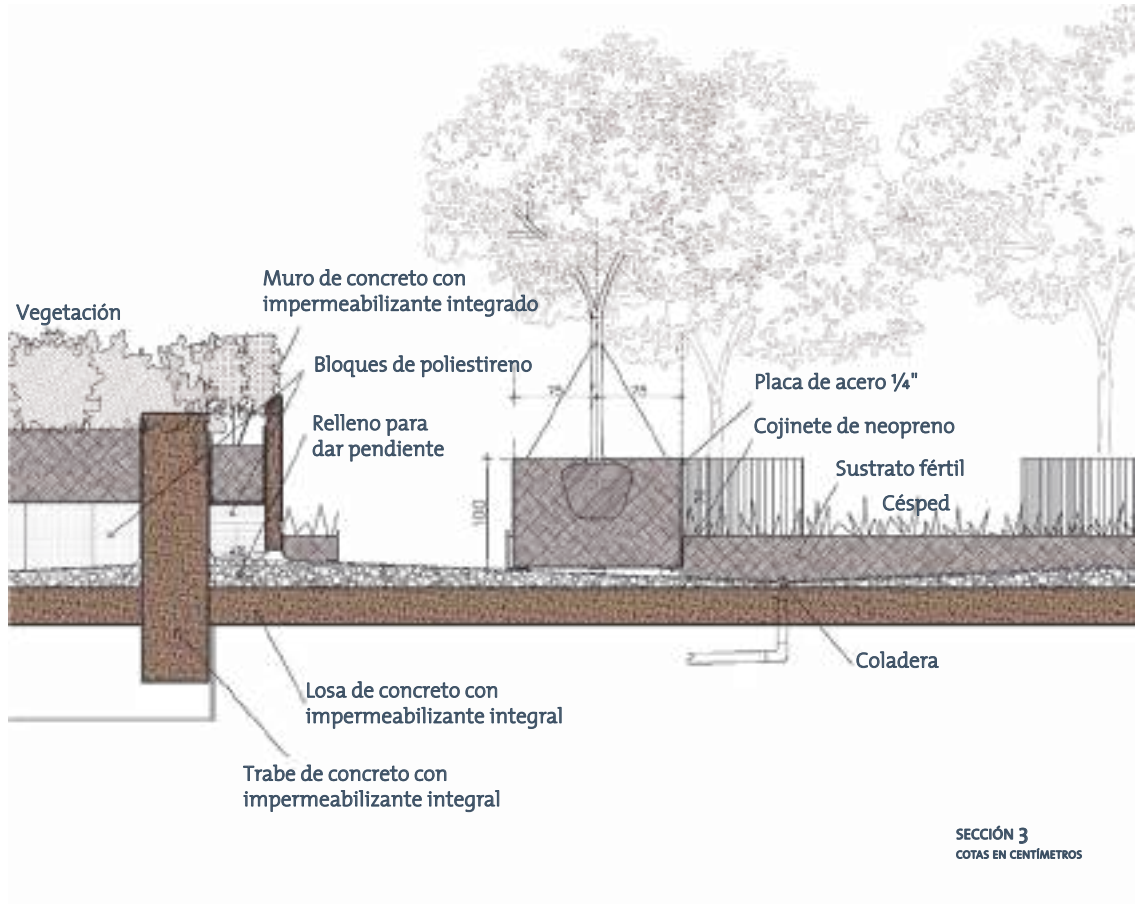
Detalles de jardineras sobre estructura, conjunto Miyana, Polanco, Ciudad de México
